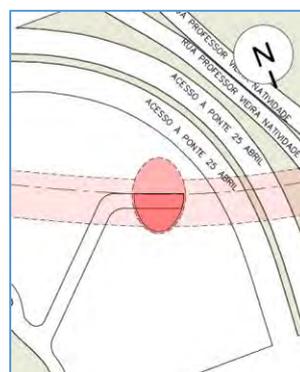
Implantação do Poço de Ventilação PV217 (Km 3+889.338)
